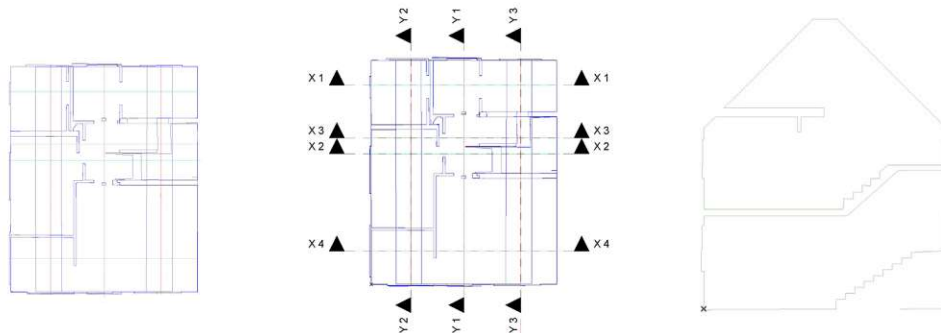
Importiertes Polyliniennetz im Grundriss (links), das damit erstellte Schnittliniennetz in Archicad (Mitte) und eine Modelliergrundlage für einen Schnitt (rechts).
